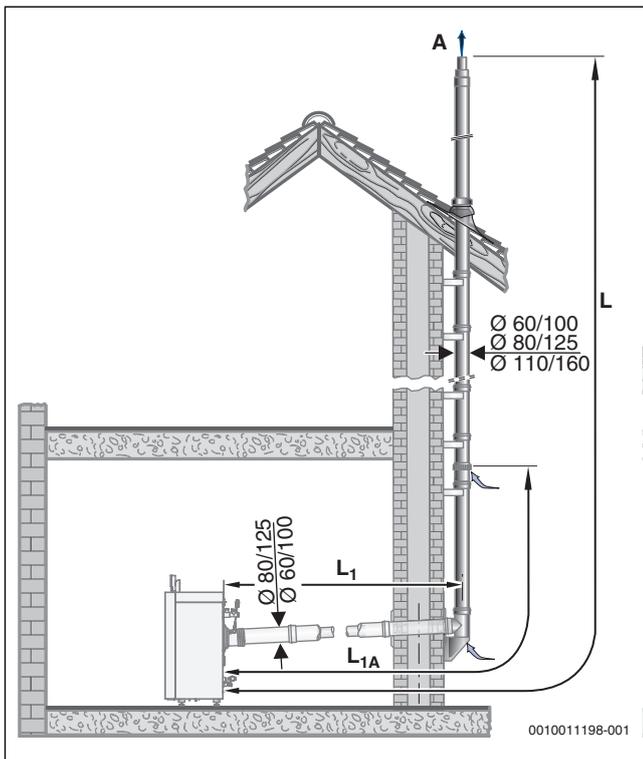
Montagevarianten mit dem Bausatz GAF-K
